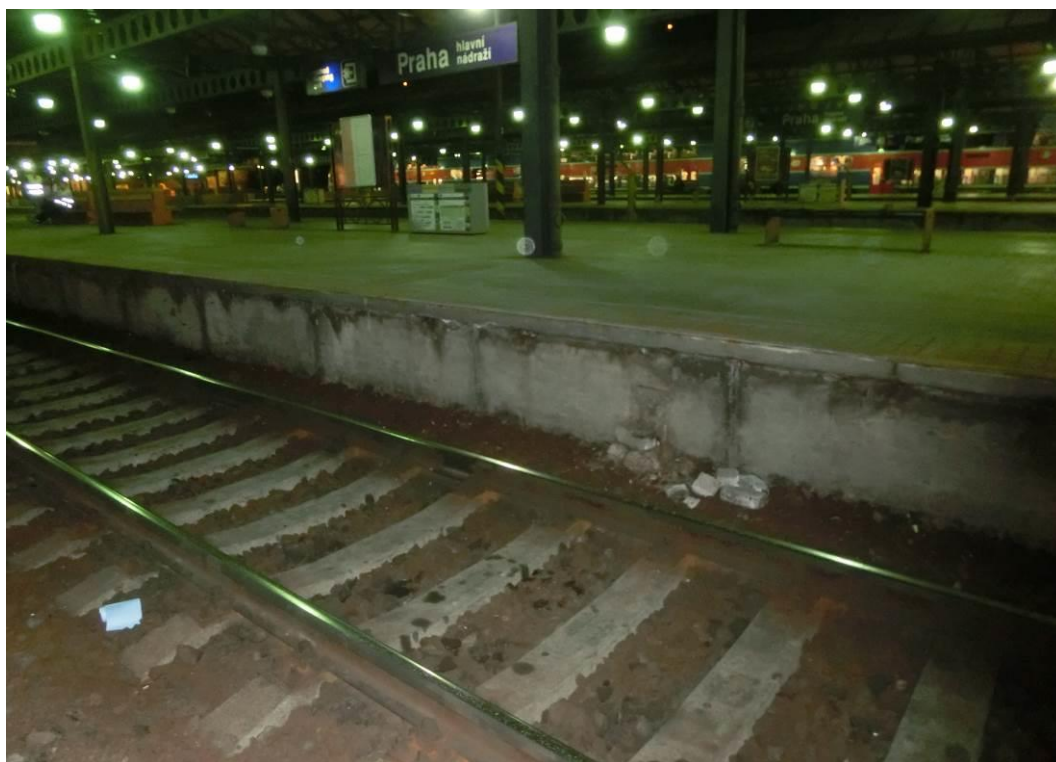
Pohled na nástupištní zídku – degradace krycí vrstvy betonu - lokální odpadávání betonu, lokální koroze výztuže a ocelového úhelníku
